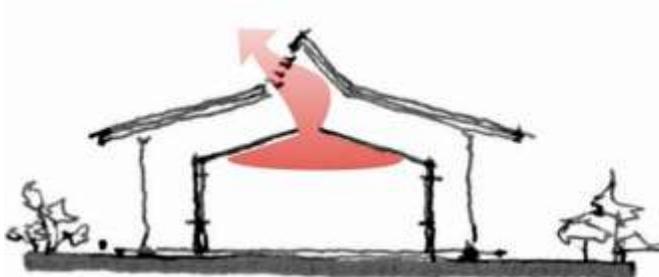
Perfil esquemático da UFAM demonstra o efeito chaminé. Croqui: CANTALICE II.
